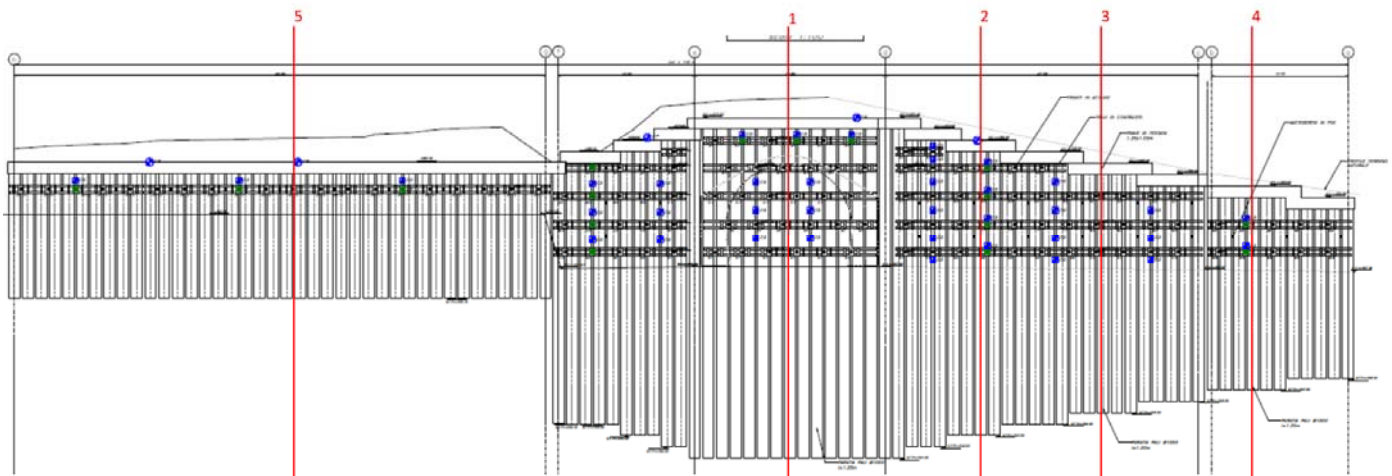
Schema della strumentazione – Prospetto dell'imbocco
